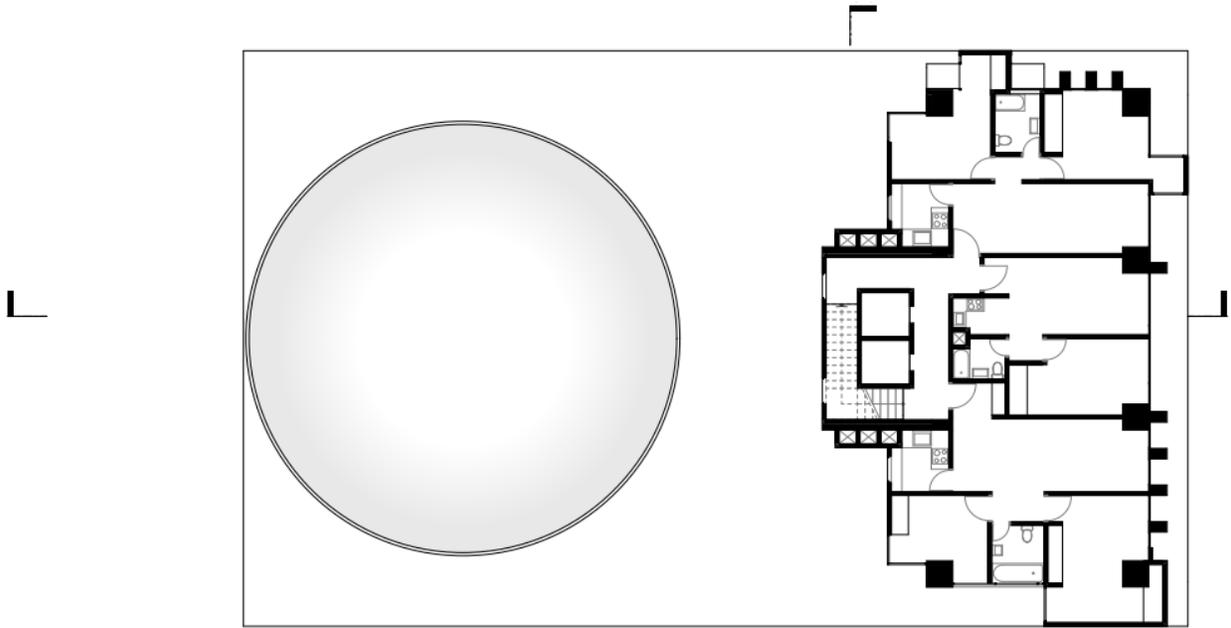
Planta alta planificada N+39.50. Fuente: Tesistas.
